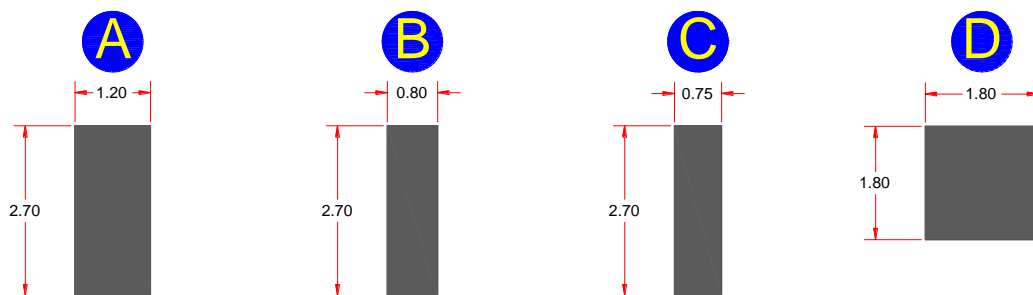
Secciones tipo de la cimentación en el distribuidor San Antonio.
